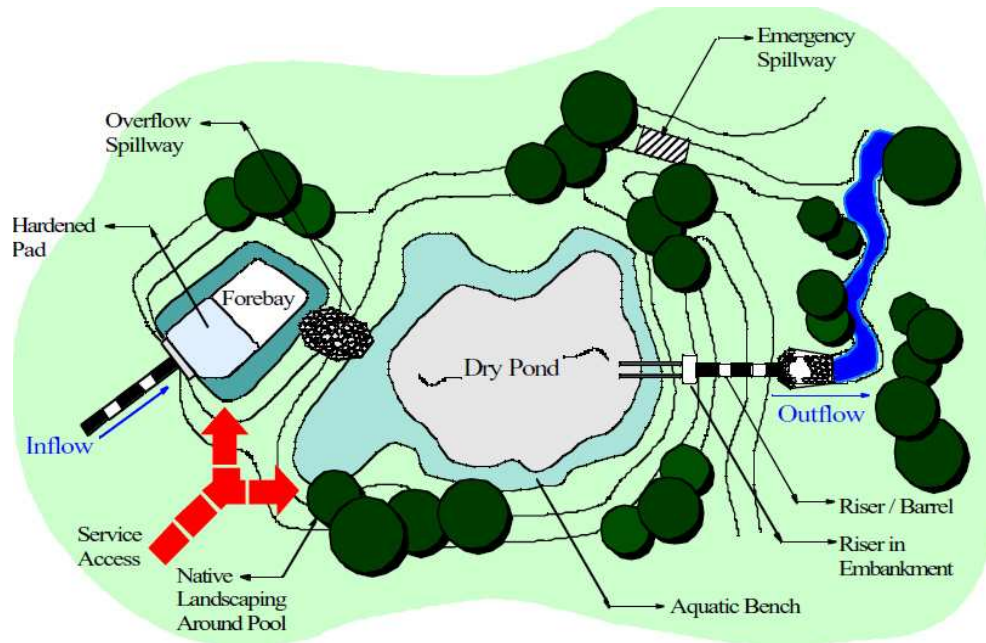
Bacias ou lagoas de Detenção Seca (Dry Detention Basins) Planta.
